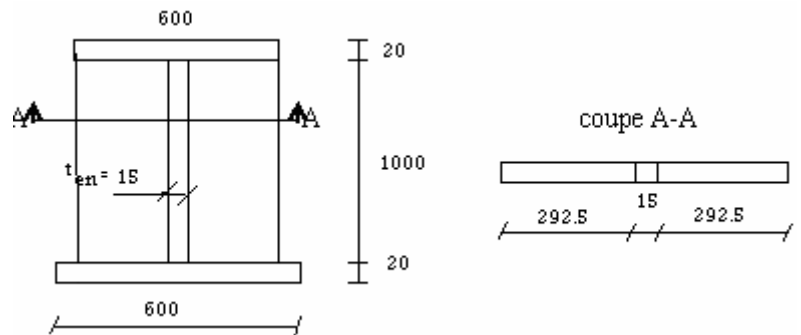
Raidisseur d'entretoise sur culée droite
